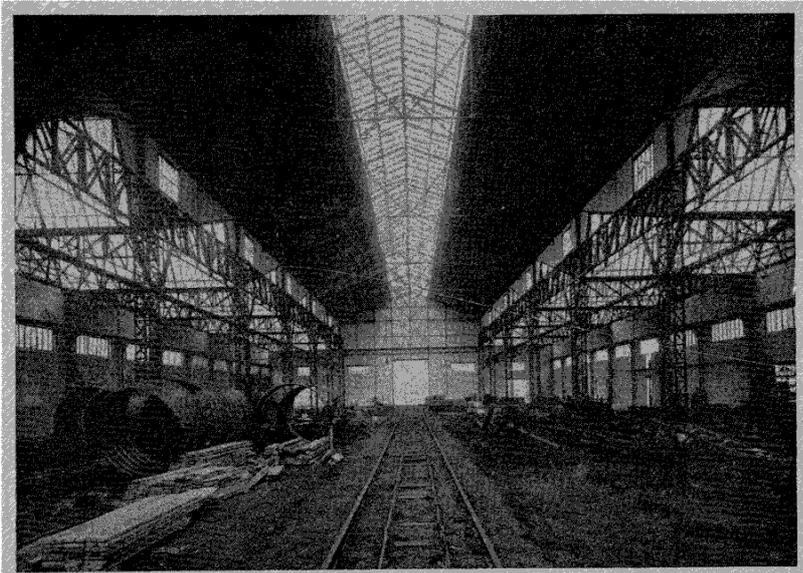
Atelier de la Soudure autogène française à Pont Sainte-Maxence, construit par soudure.
